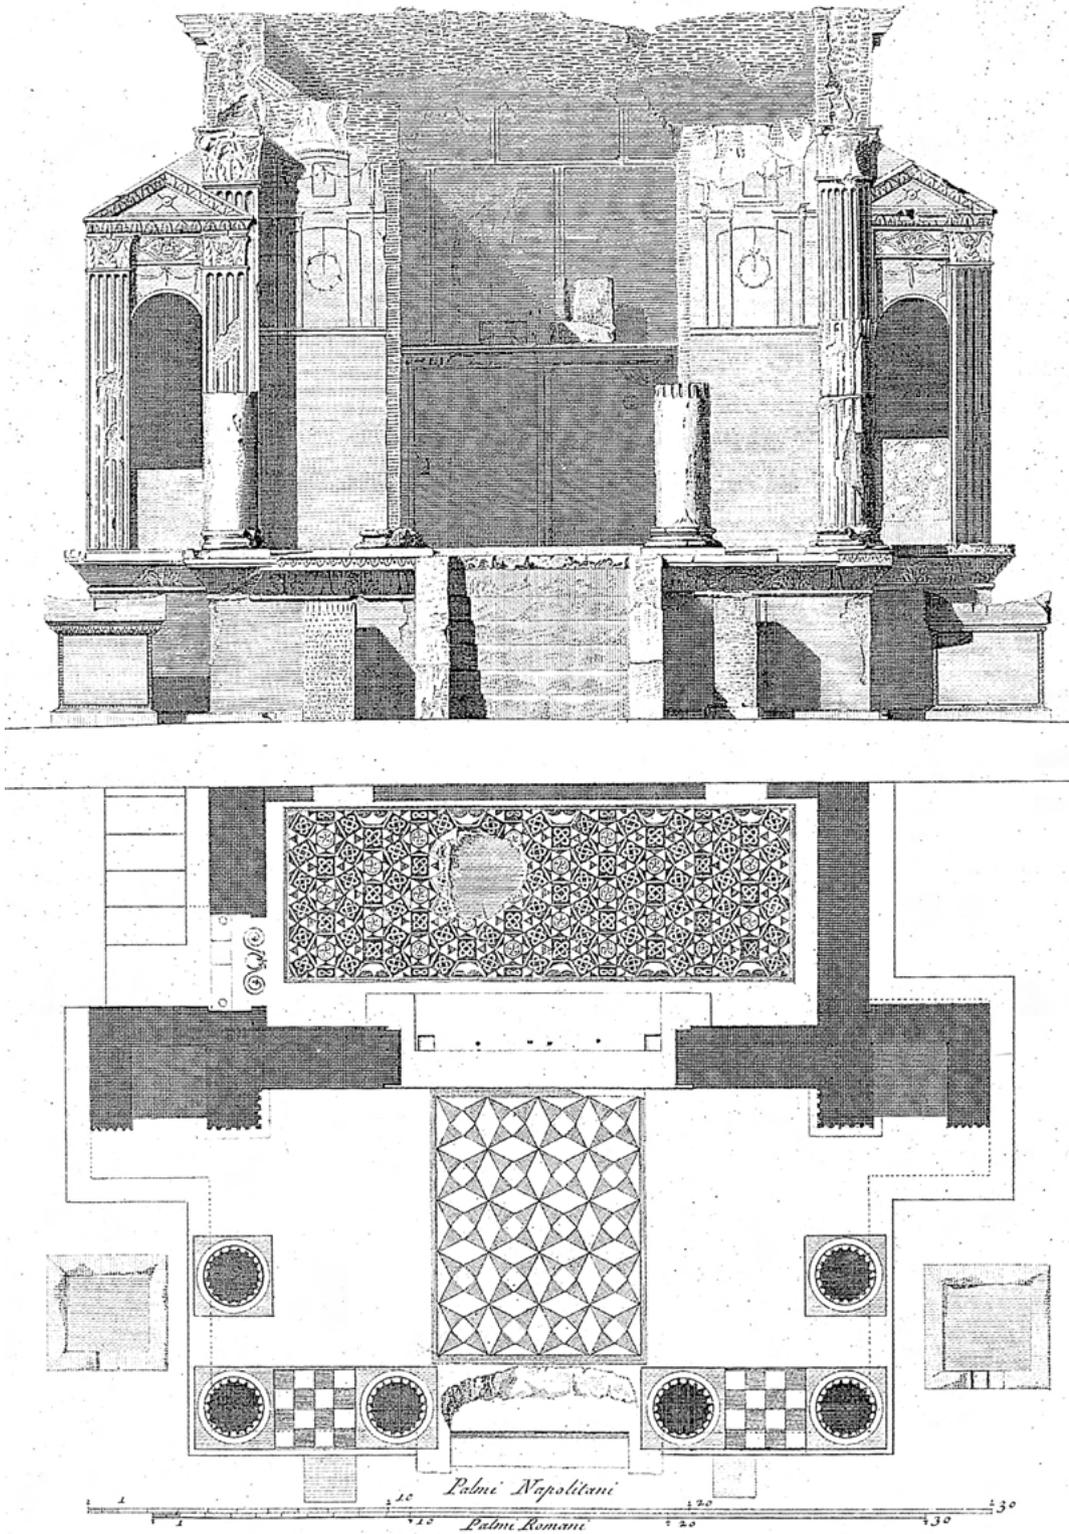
Isis-Tempel, Grundriss mit Angabe des Paviments (F. La Vega und C. Nolli)
